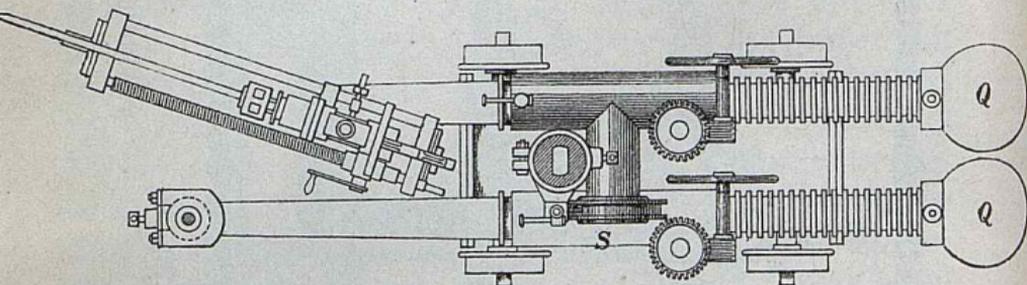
Humboldt'sches Gestell für Bohrmaschinen.
